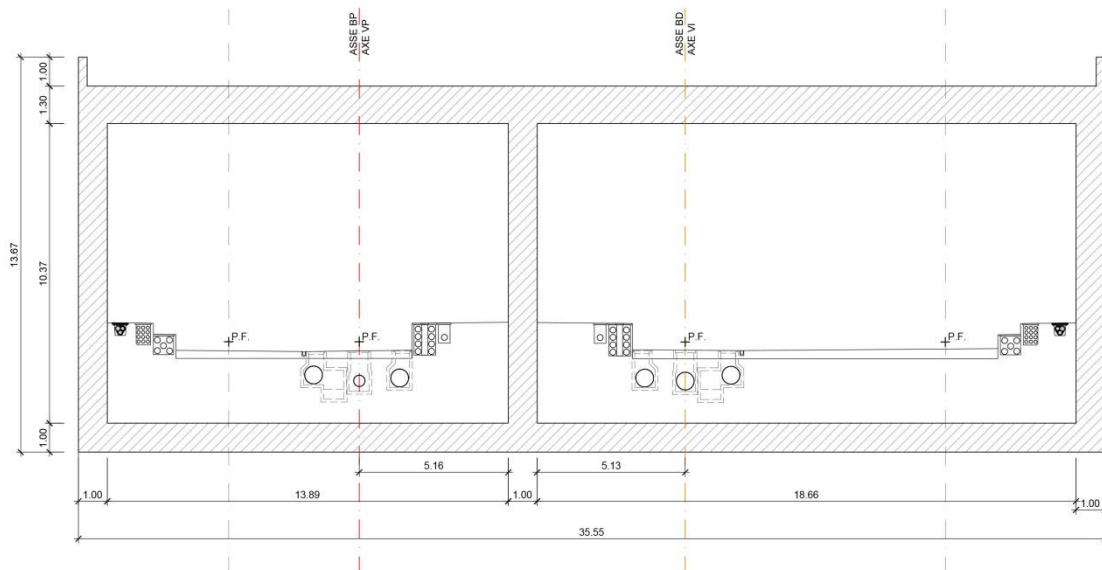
Sezione tipo galleria artificiale BP pk 61+076 – 61+084
